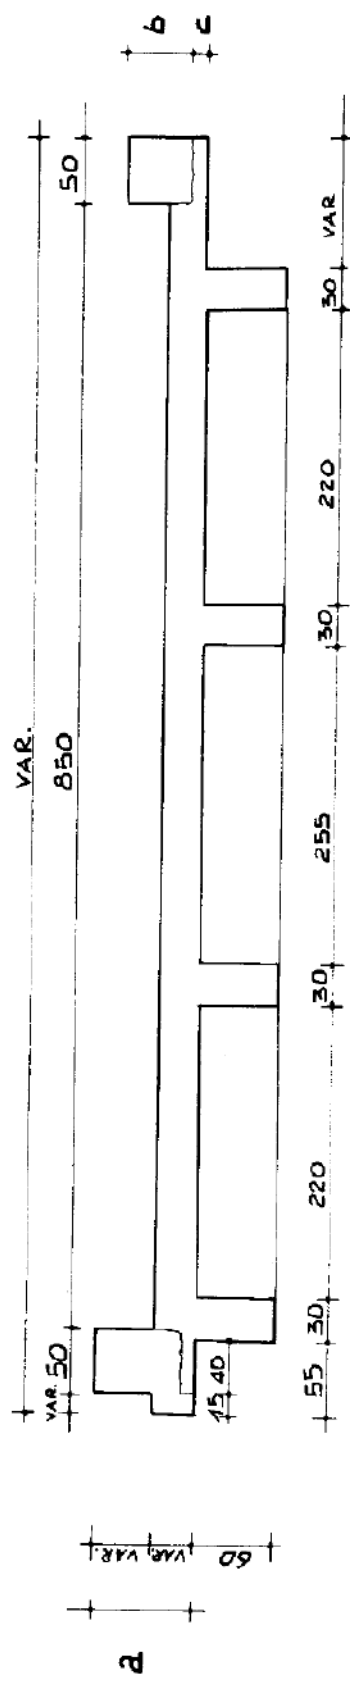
Dettaglio dello stato di fatto della pianta con orditura travi – struttura “a cassettoni” (e traccia pile) del ponte TENZA [n16.B], dettaglio al giunto.
